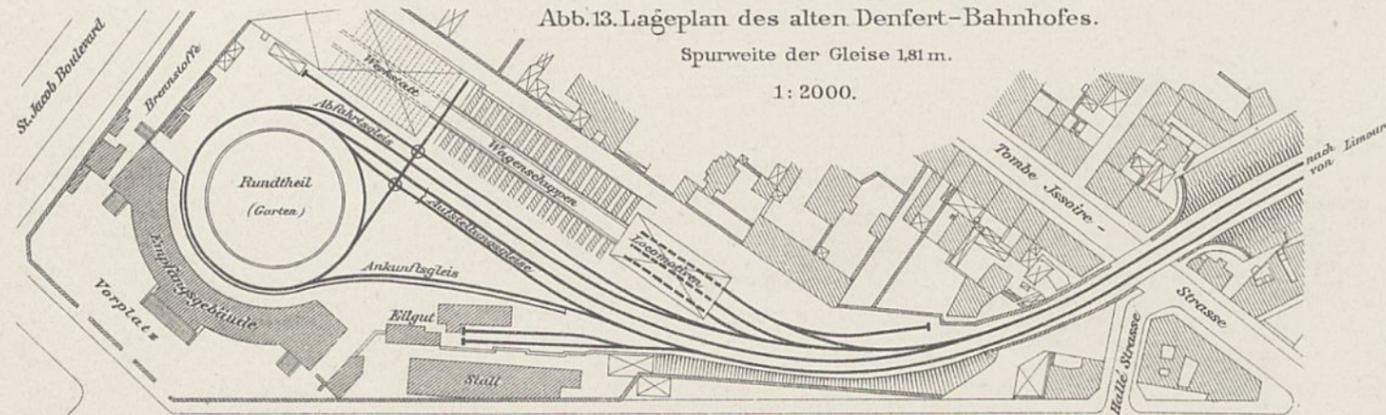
Lageplan des alten Denfert-Bahnhofes.
